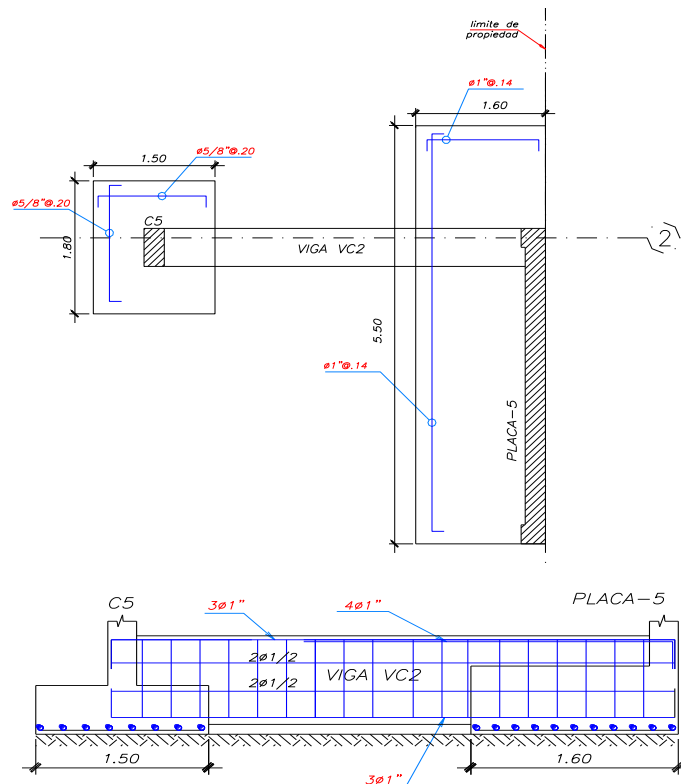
Diseño Final de la Zapatas Conectadas con cargas de la Norma E.030-2014
